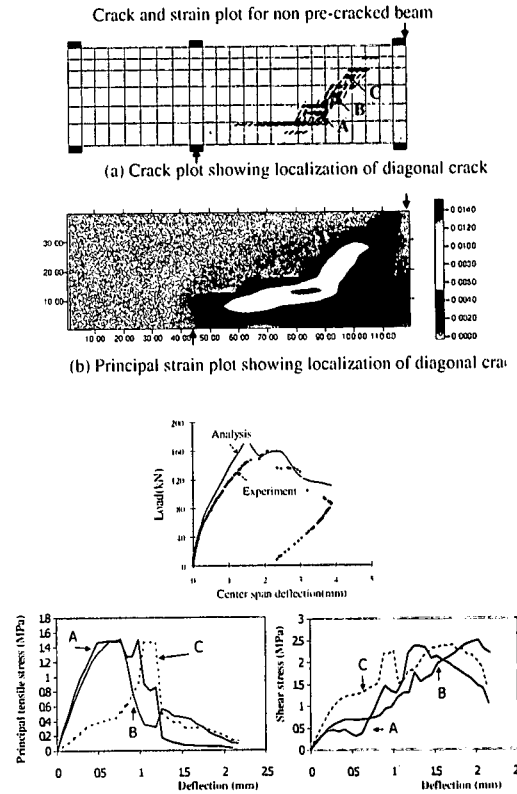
先行ひび割れの無い梁のせん断破壊と局所応力
